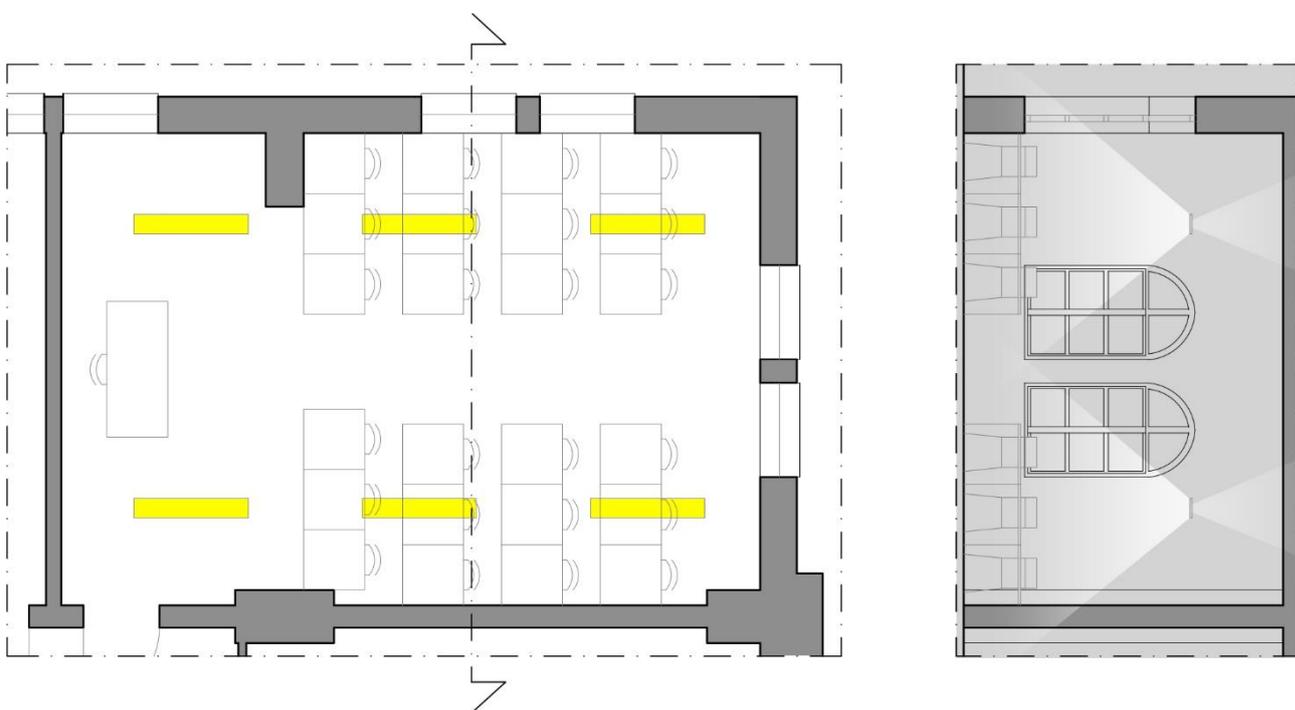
Pianta e sezione fuori scala dell'aula tipologia 3 con disposizione dei banchi e degli apparecchi.
